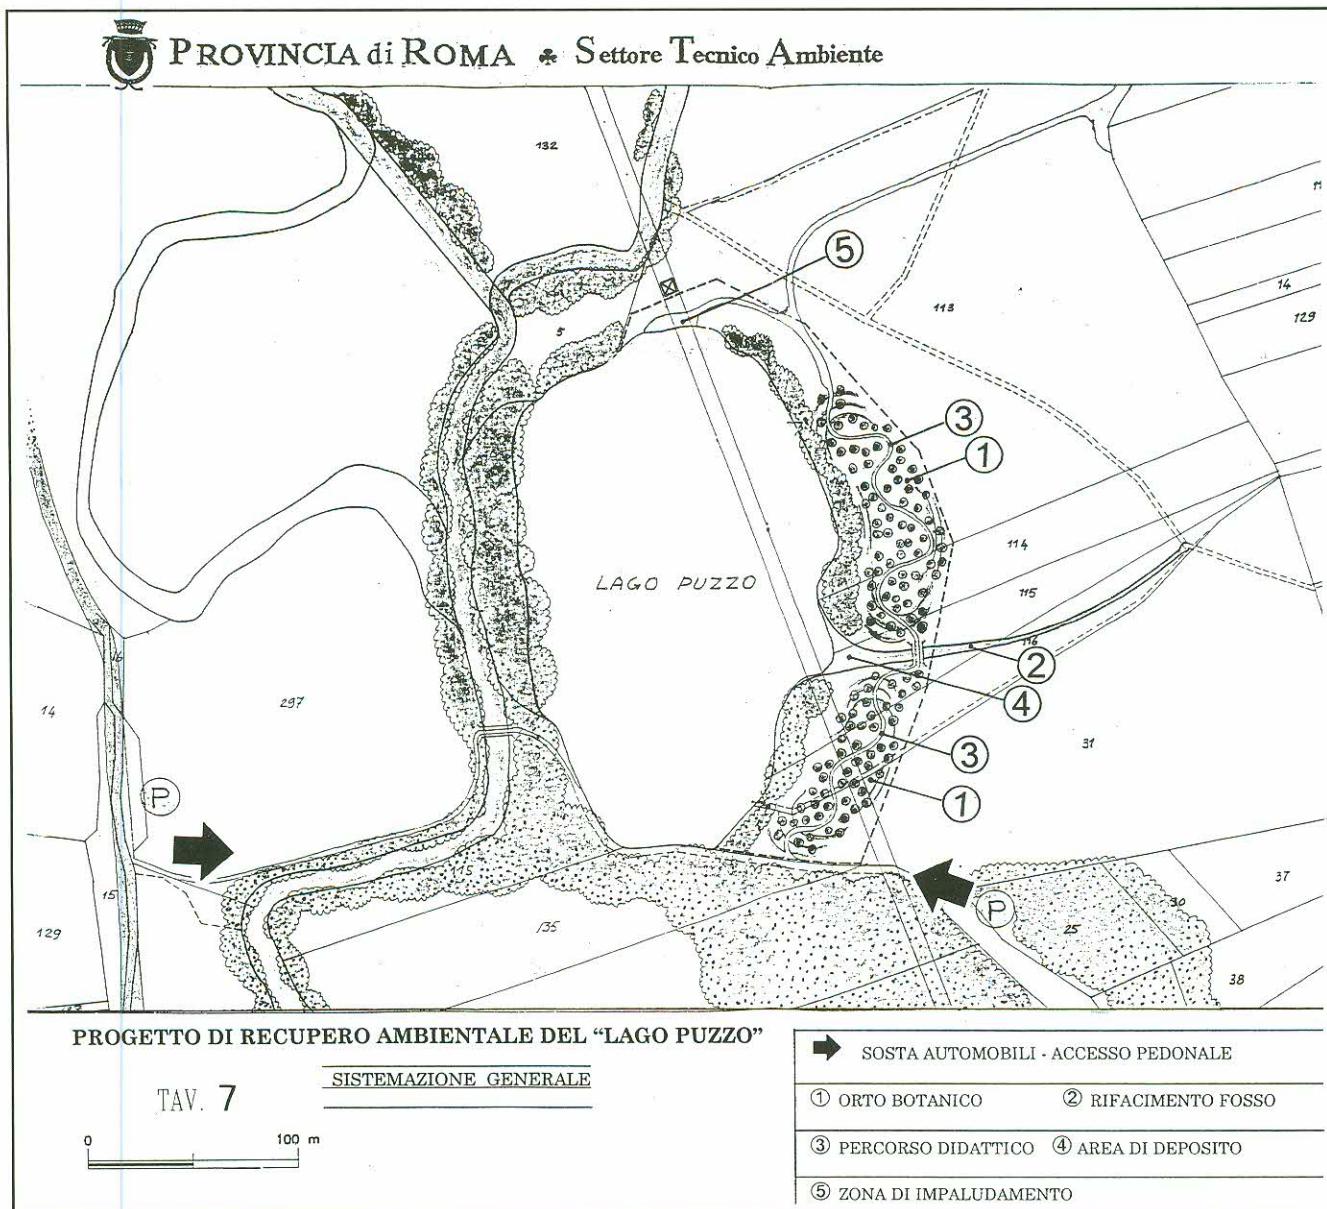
Planimetria con gli interventi di sistemazione generale dell'area.
